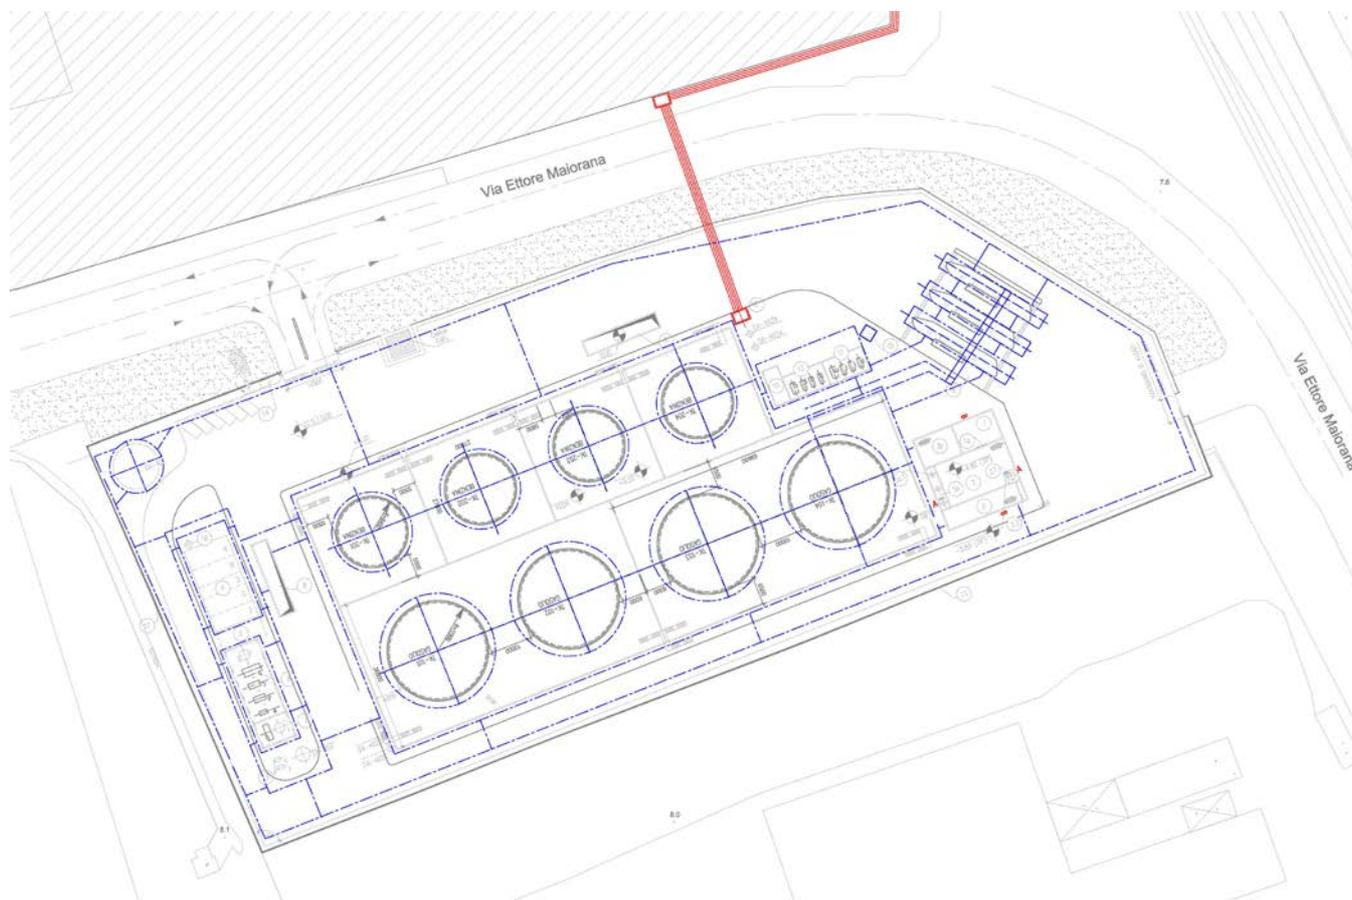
LAYOUT IMPIANTO DI MESSA A TERRA
